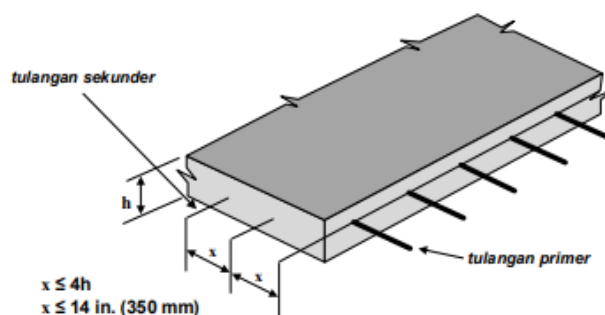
8 Tulangan slab dua arah yang dipikul oleh girder, balok, atau dinding beton bertulang
